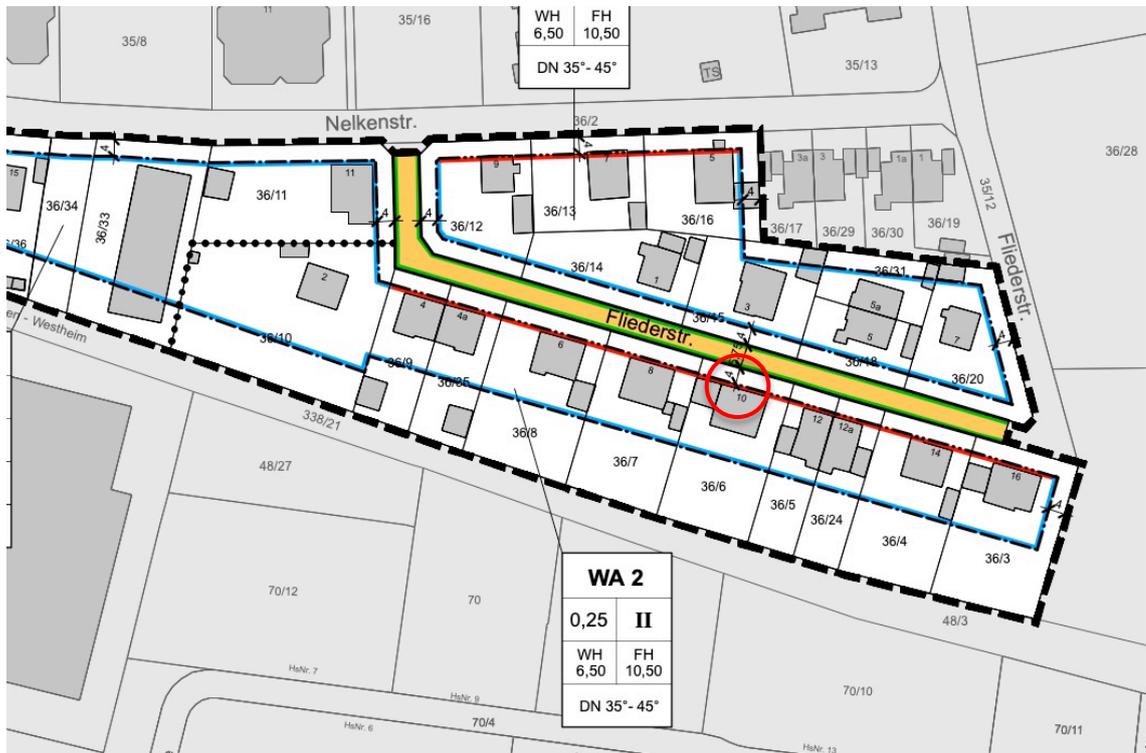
rechtskräftiger Bebauungsplan (o.M.)
